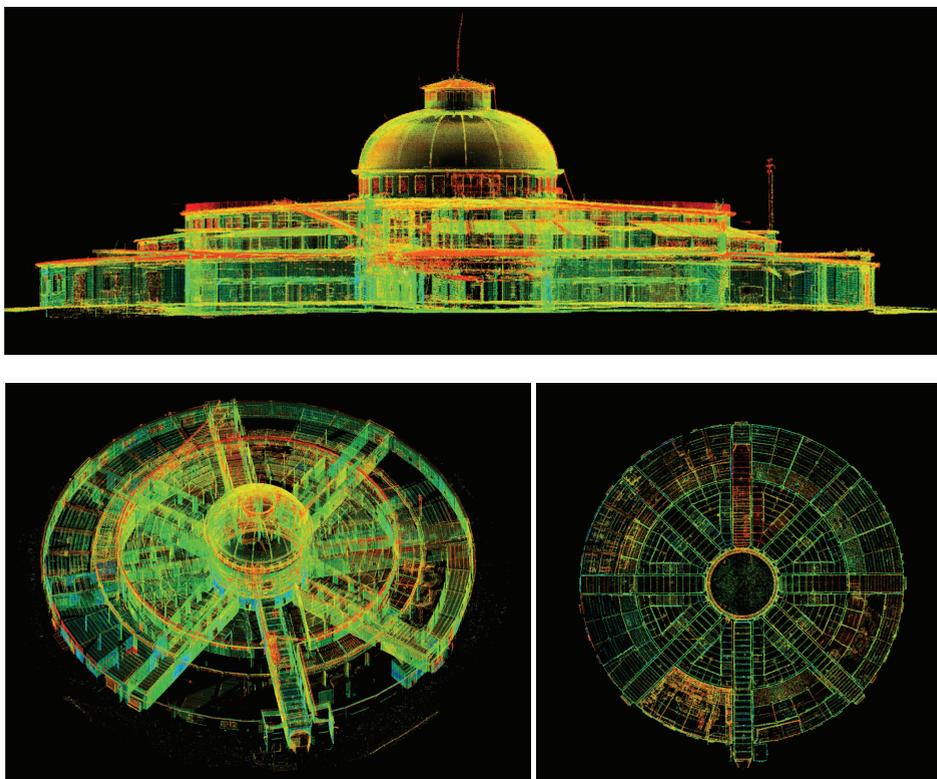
Dall'alto: vista laterale, vista inclinata e vista dall'alto del modello 3D.
